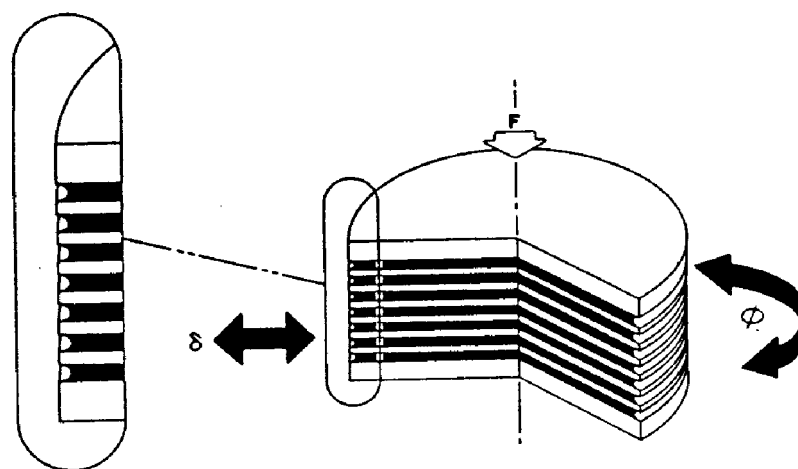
Схема нагружения упорного цилиндрического подшипника
